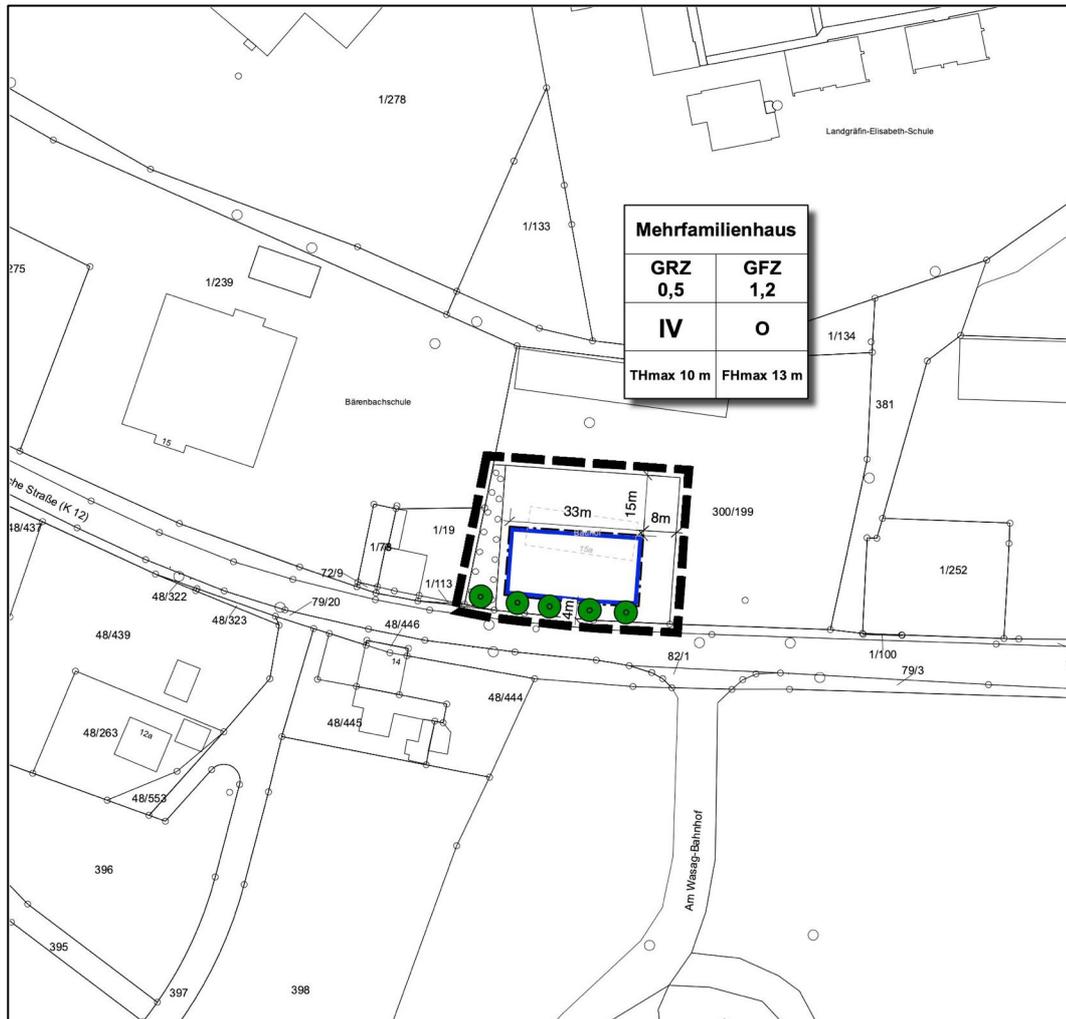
Bebauungsplan Nr. 15 „Niederrheinische Straße, 1. Änderung“
